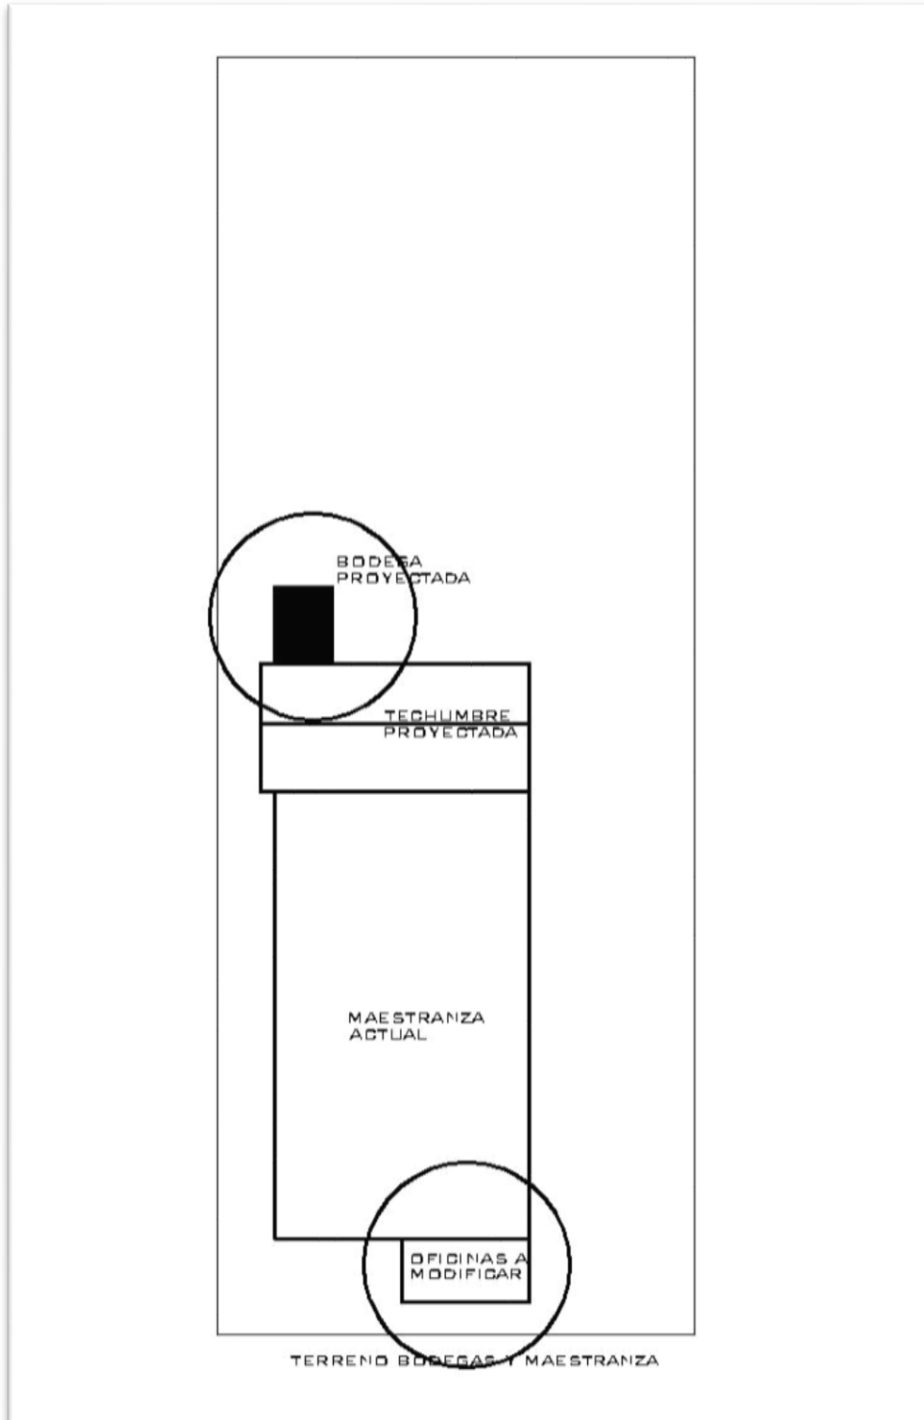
5: Planta maestra y proyección de bodegas y oficinas
